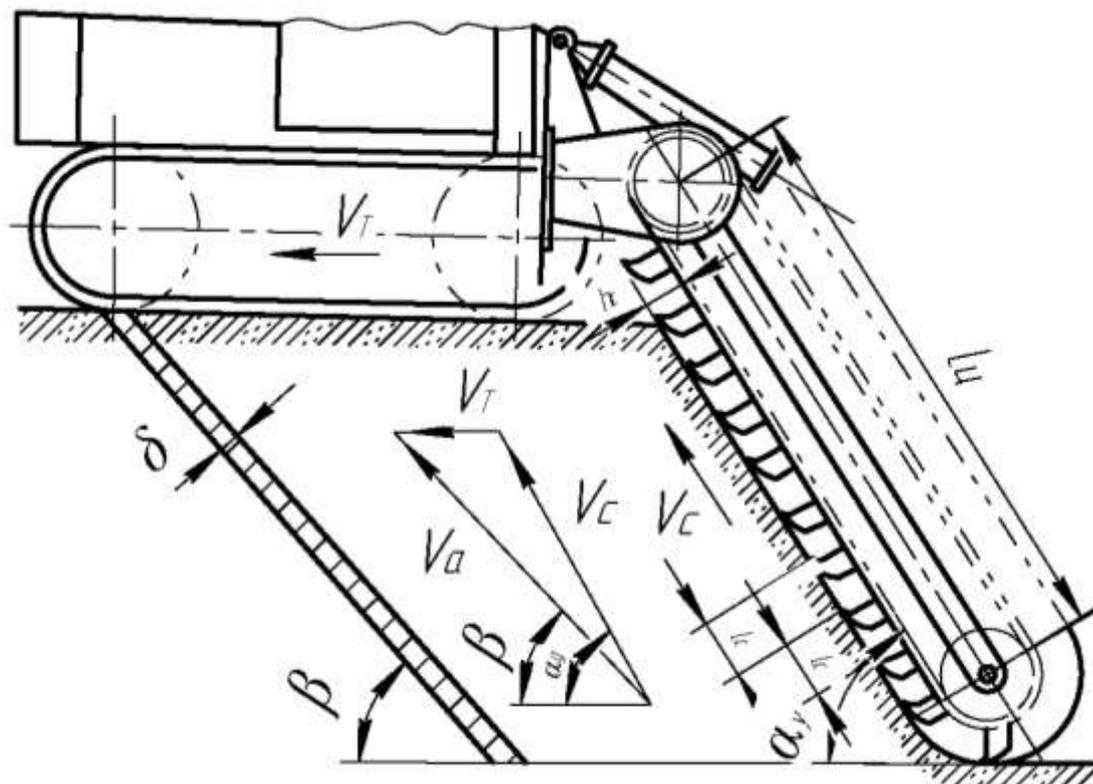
Схема машины со скребковым рабочим органов продольного копания, разрабатывающим грунт по совмещенной схеме (тип IV)
